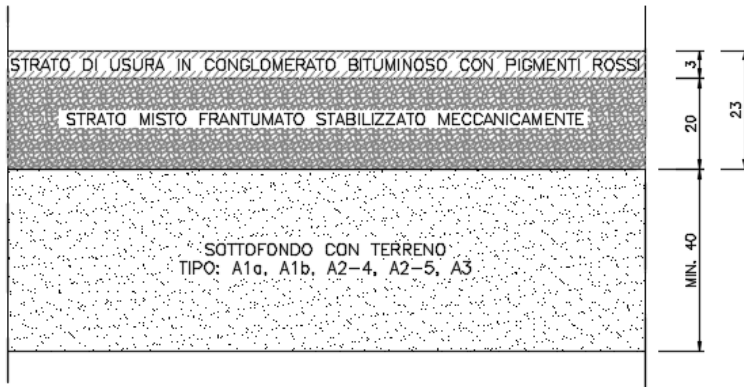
sezione tipo della pista ciclopedonale in rilevato
